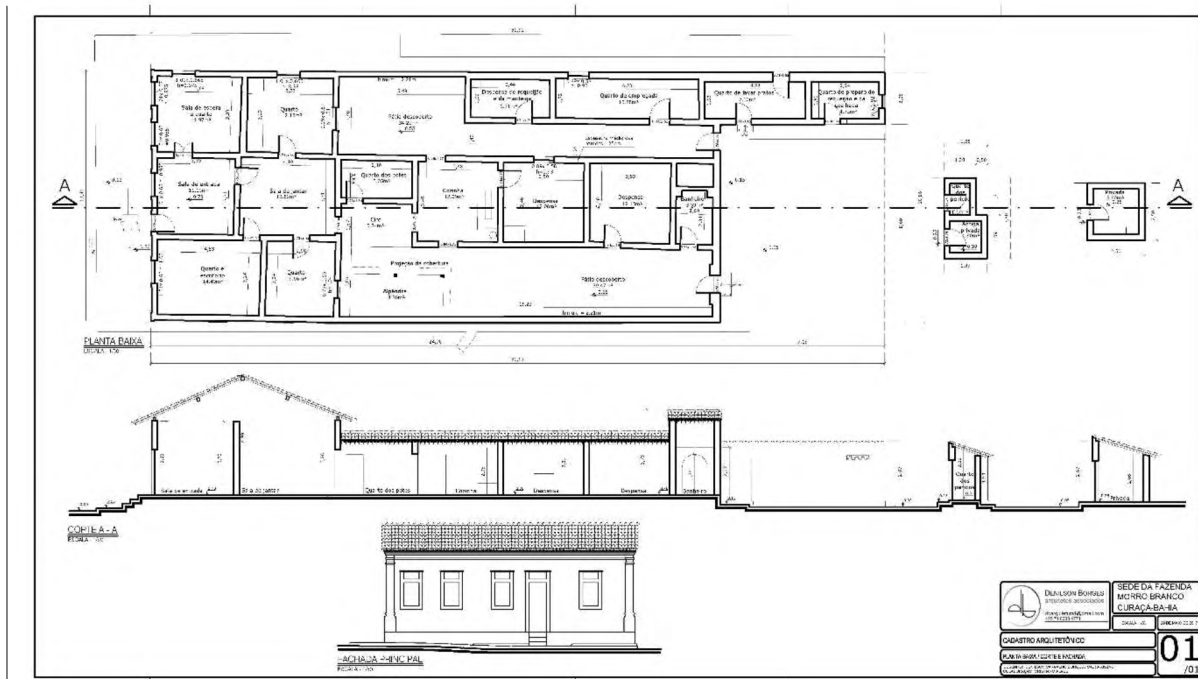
Planta baixa, corte e fachada da Sede da Fazenda Morro Branco. Cadastro araquidônico efetuado por Denilson Borges Arquitetos Associados, Salvador, Bahia, 2017.
